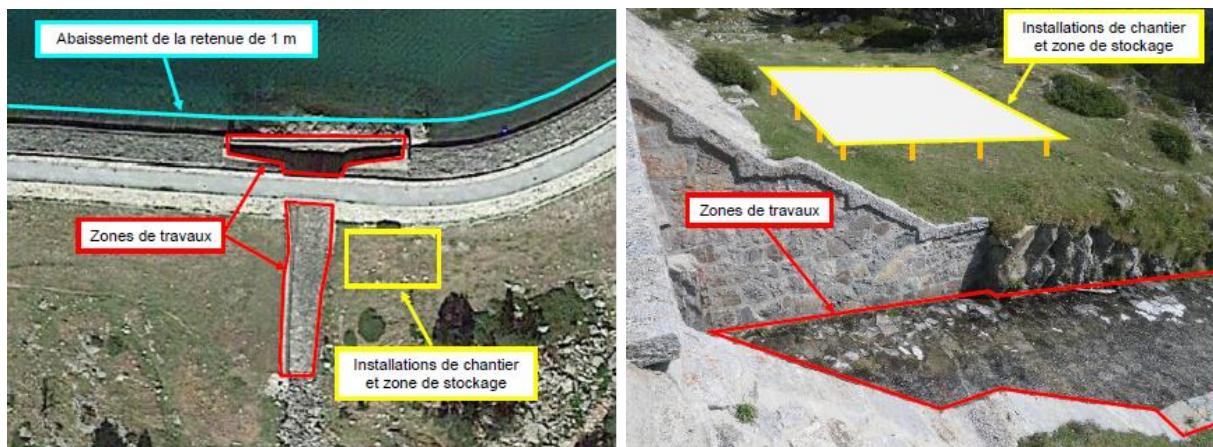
installations de chantier en rive gauche du chenal d'évacuation
